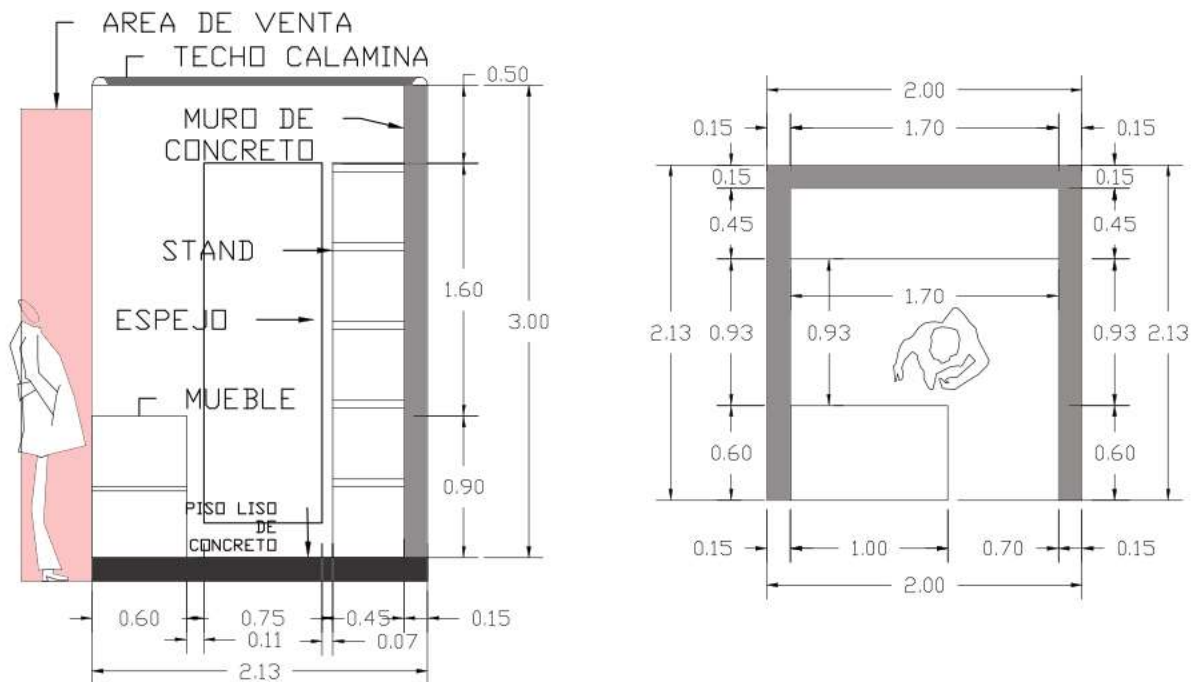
Corte Detallado del Puesto de Ropa y Joyería y Planta / Elaboración propia
